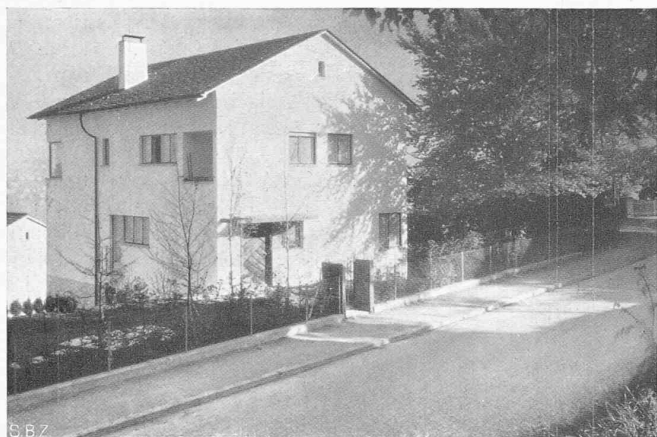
Haus Arch. Hans Roth, alte Landstrasse Kilchberg, aus NW.
